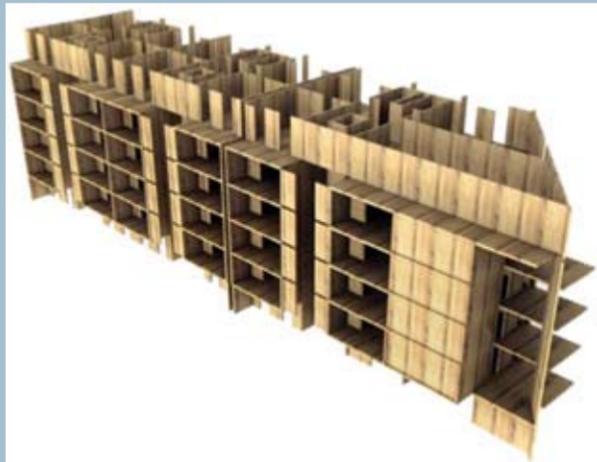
Schema delle strutture in pannelli di legno massiccio di un edificio di 6 piani in progetto a Firenze.
